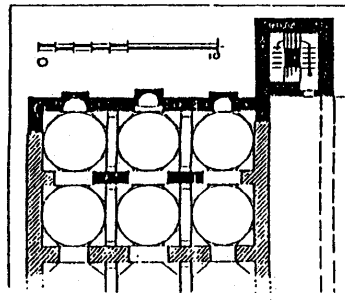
مسقط أفقي لمدرسة وقبة المنصور قلاوون بالقاهرة (عن Creswell) .
